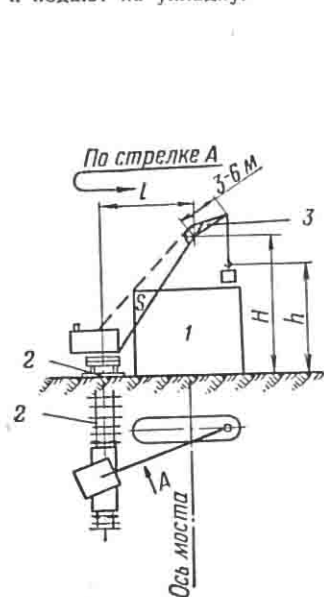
Подача бетона в опору полноповоротным краном на железнодорожном ходу:
